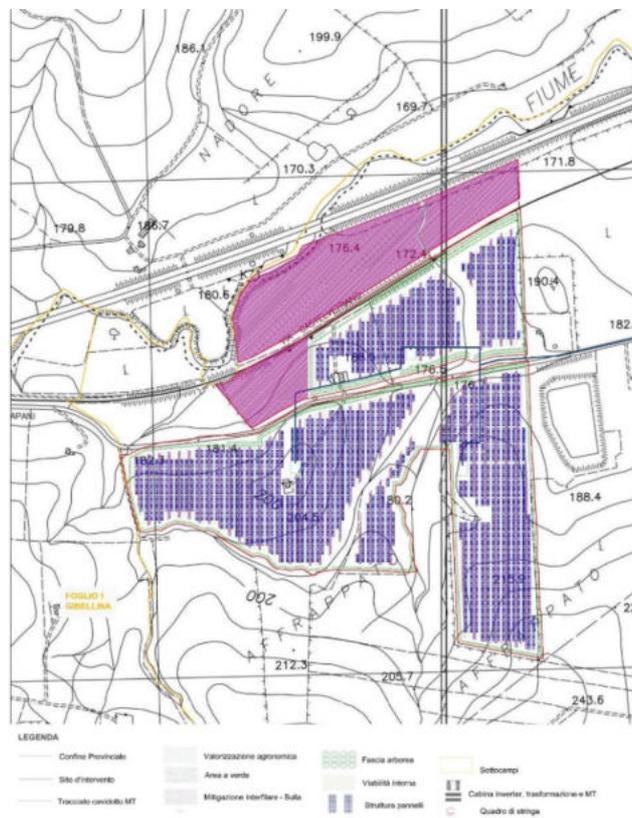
B – Layout dell’impianto ricadente in Contrada Magione con cavidotto
